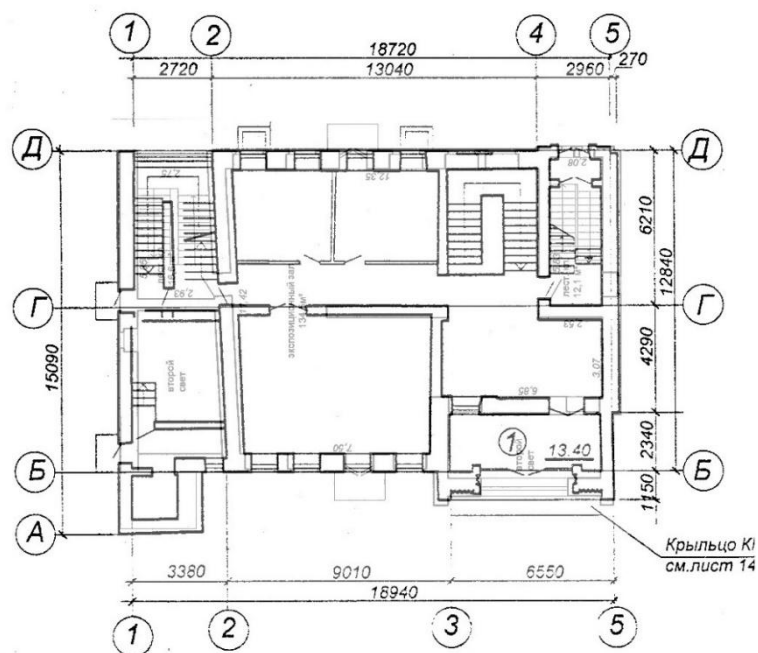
Готовый чертеж 1, 2 и 3 этажа
